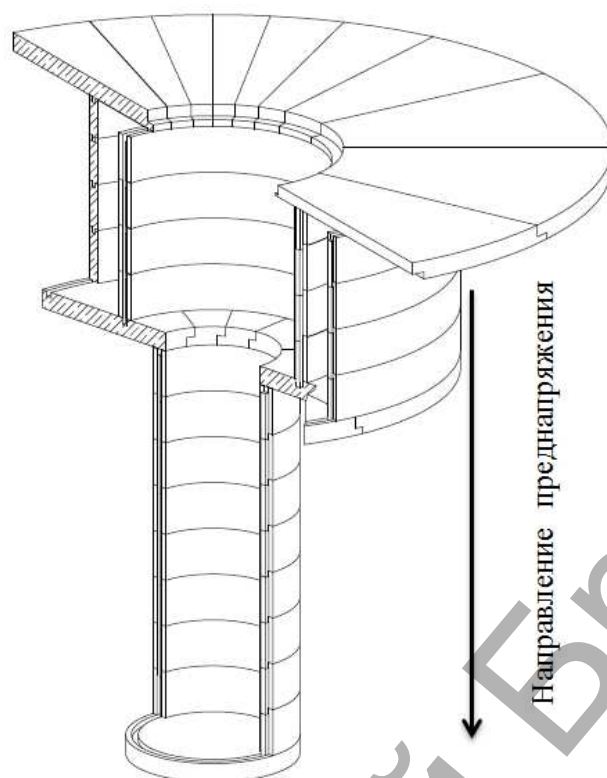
Сборное СФС шахтного типа с предварительным напряжением арматуры на бетон вдоль ствола
